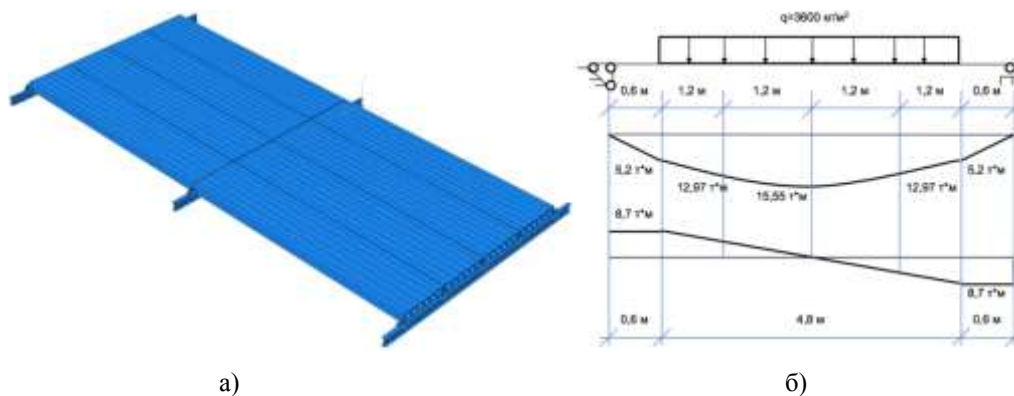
Расчетная схема фрагмента сталежелезобетонного перекрытия.
